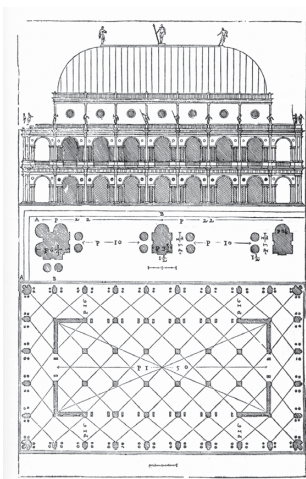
Desenhos do Palazzo della Ragione de Vicenza, do tratado *I quattro libri dell'architettura*. Fachada, planta baixa e detalhe das ordens sobrepostas da fachada. Intervenção projetada por Andrea Palladio na década de 1540.
